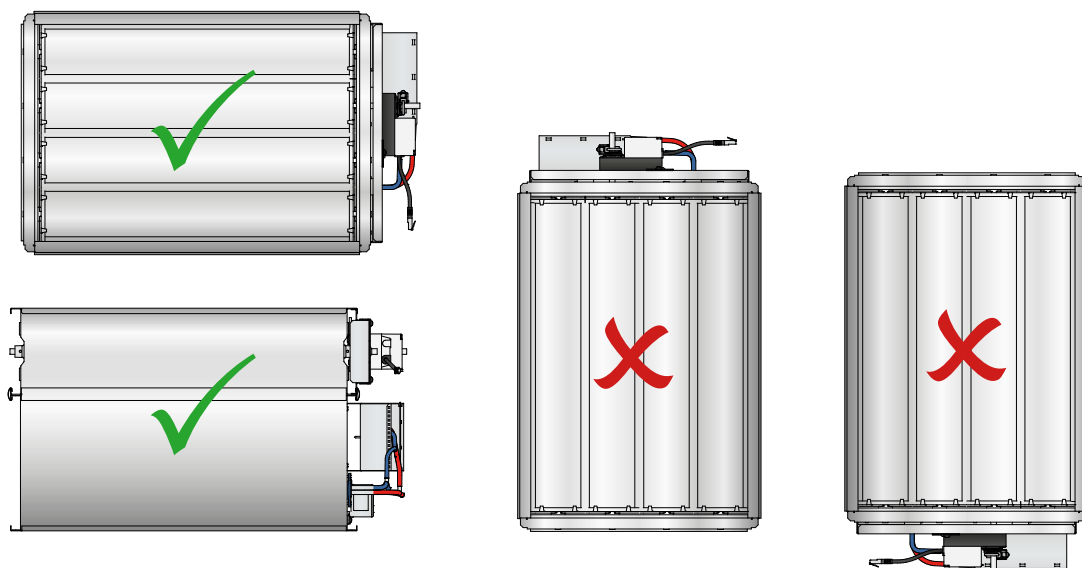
Installation - Les axes du registre doivent être installés horizontalement.
